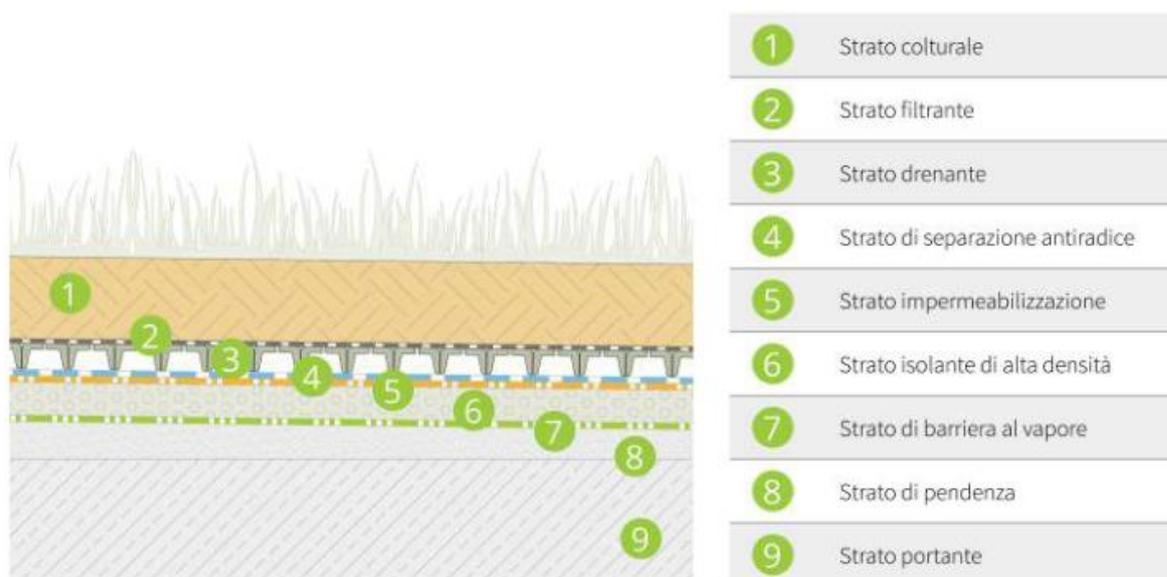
sistema Il.A.Da.Is. (intensivo leggero, piano, drenaggio artificiale, isolato termicamente).
